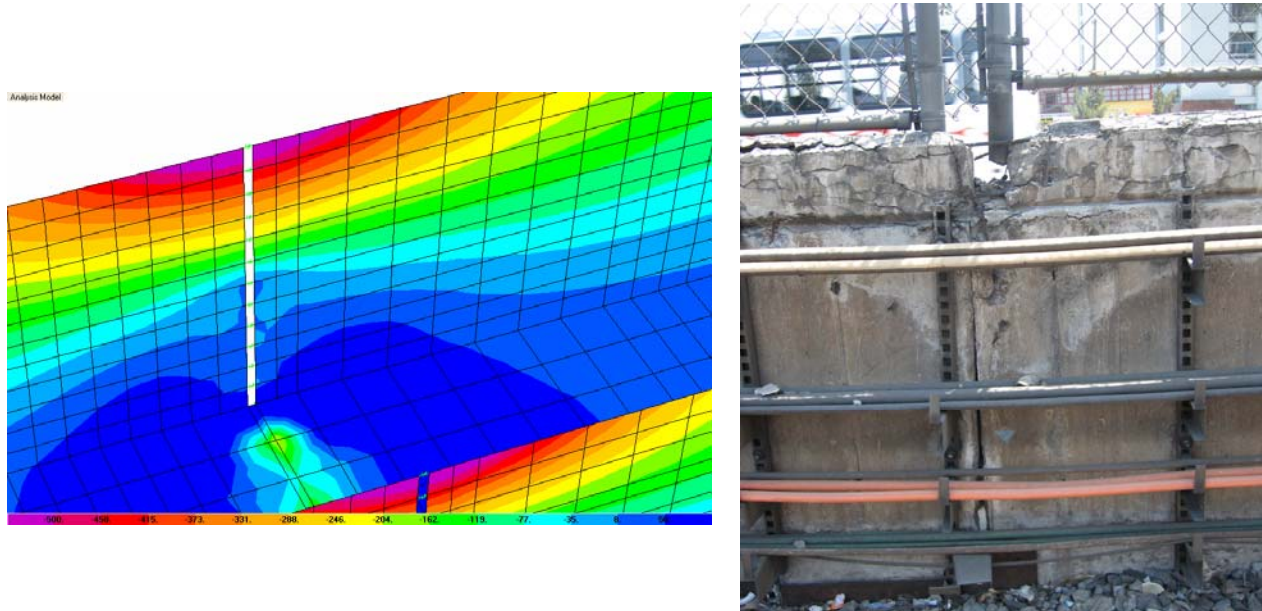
(a) Distribución de esfuerzos junta constructiva tipo, (b) falla observada en las juntas de construcción.
